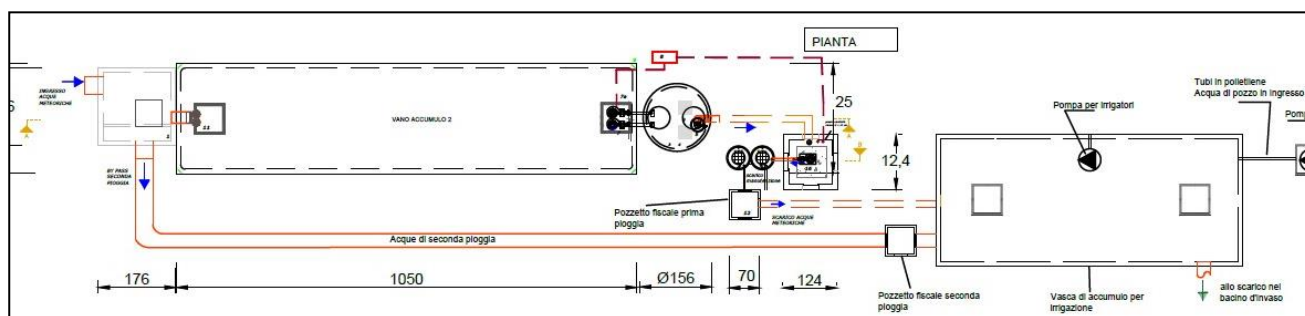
Planimetria dell'impianto di depurazione – Tavola 7
